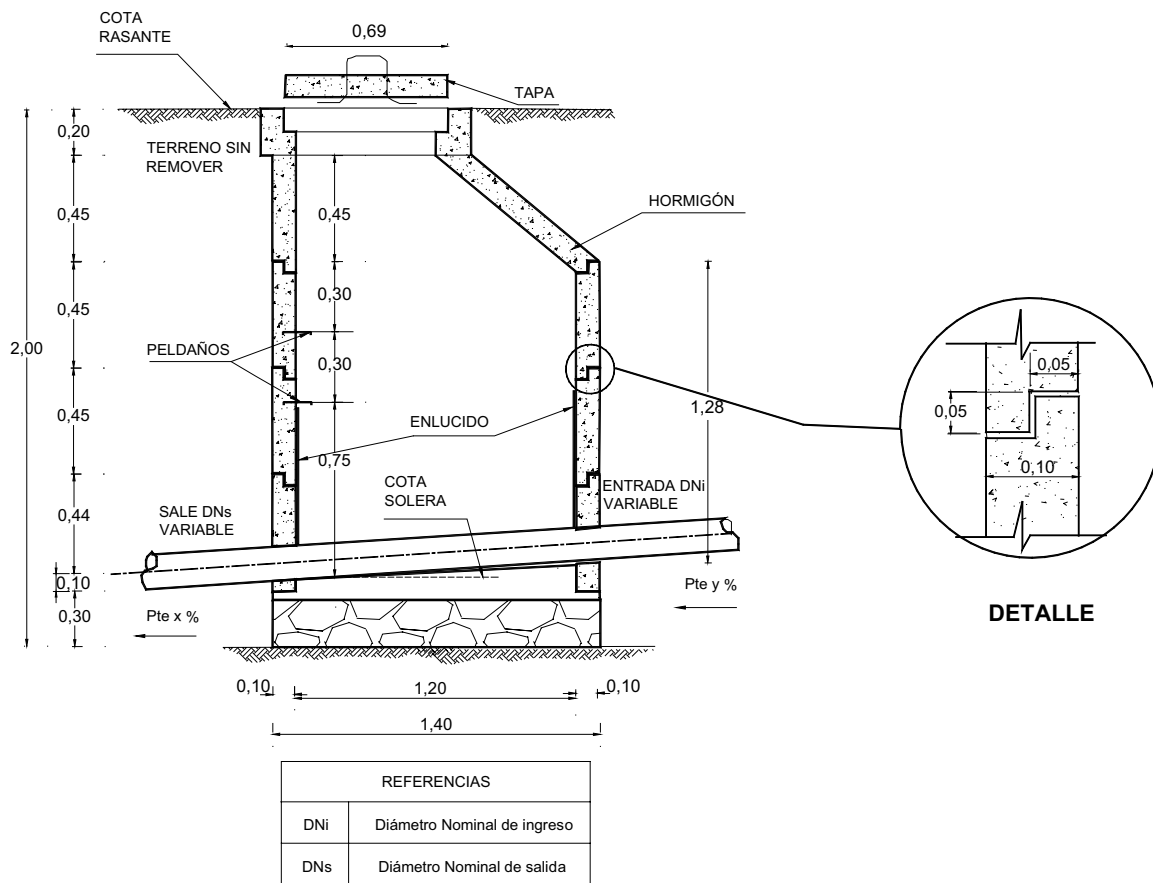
Cámara de inspección prefabricada tipo en red pública
